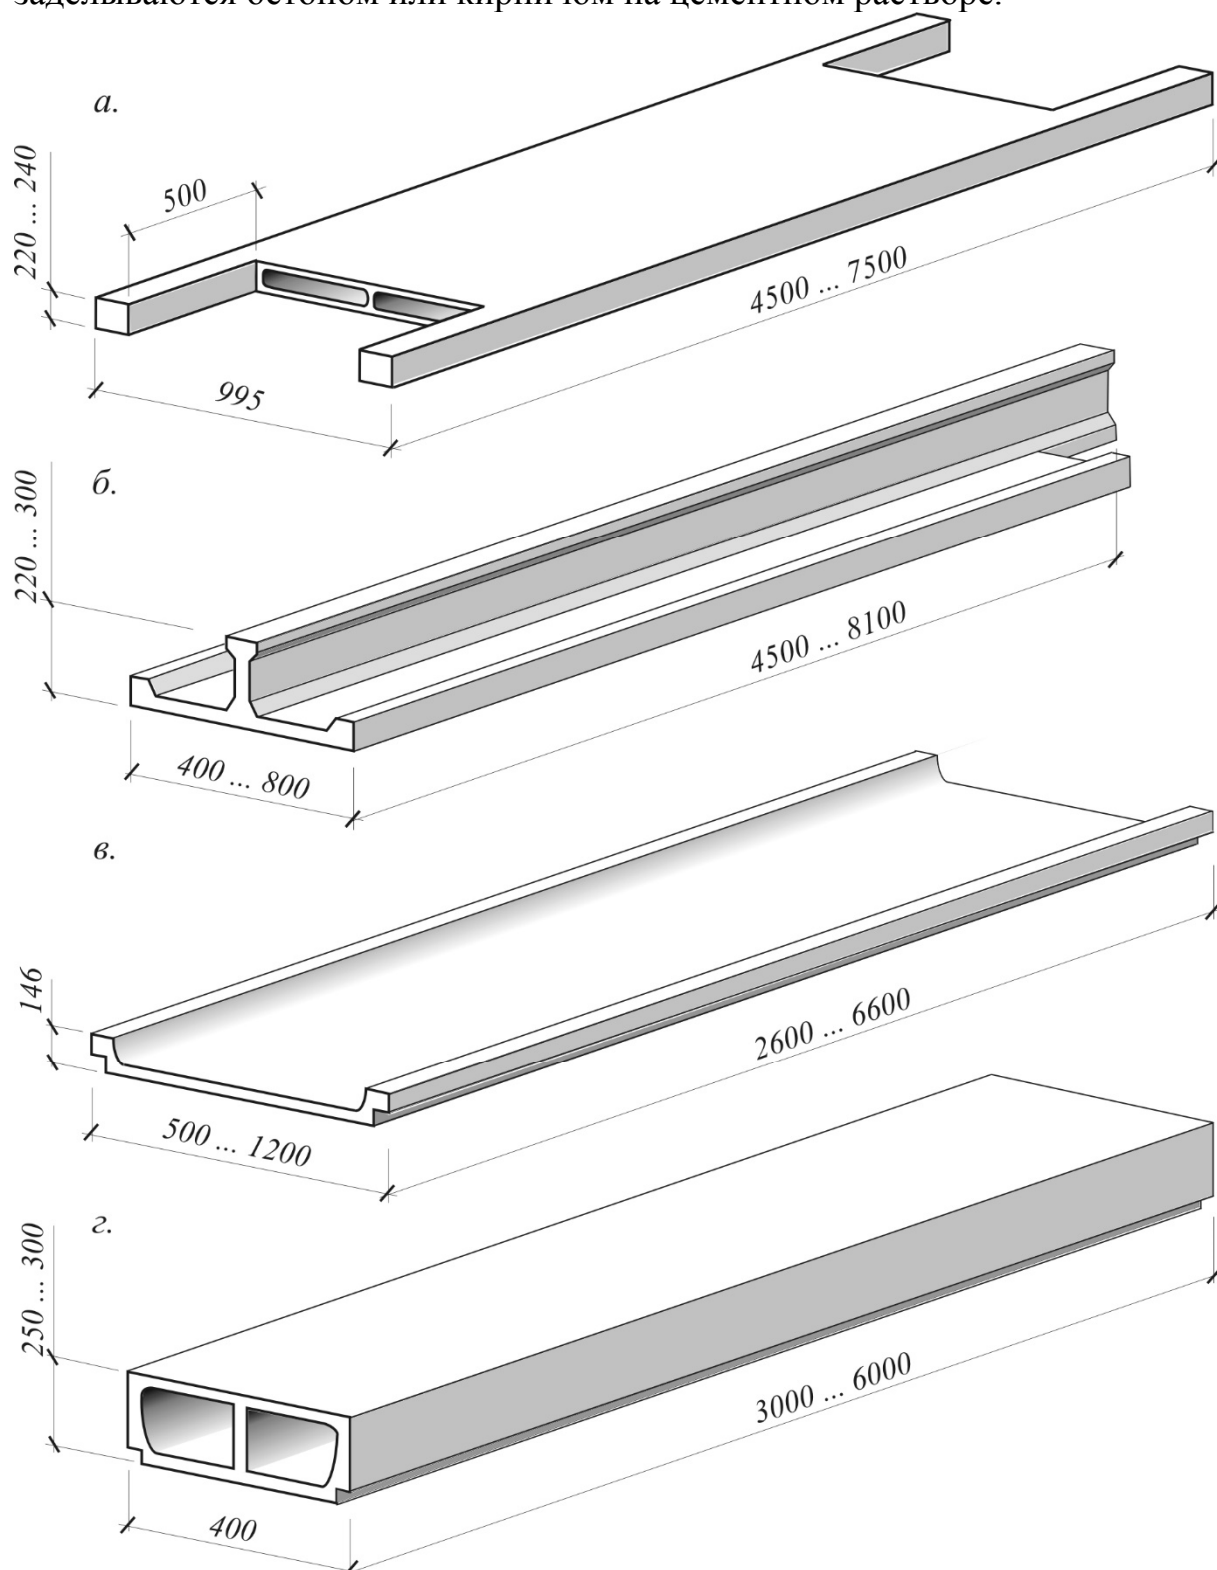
Железобетонные элементы, используемые при замене перекрытий:
